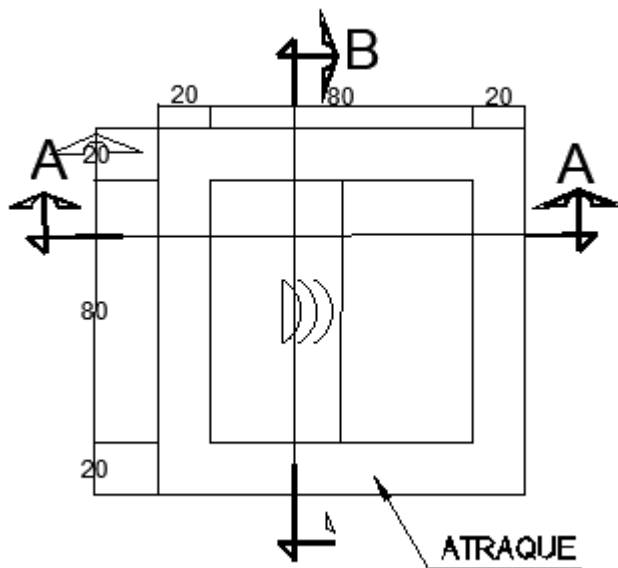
Diseño de planta de atraques de concreto para tubería de acero negro.
